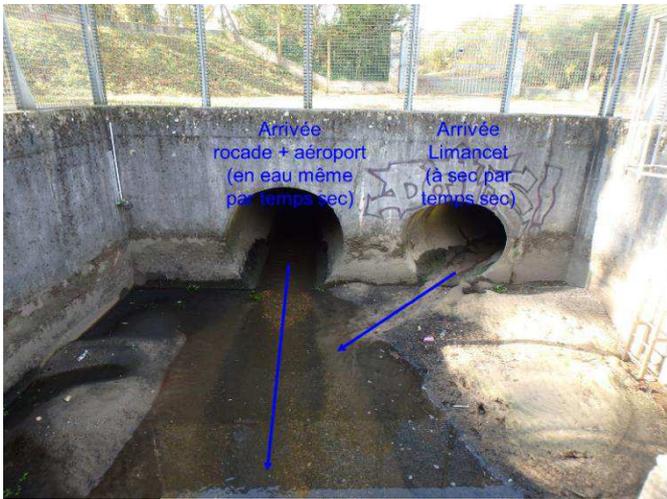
Site de Bois Gramond, lieu d'installation du pilote de traitement des eaux pluviales
